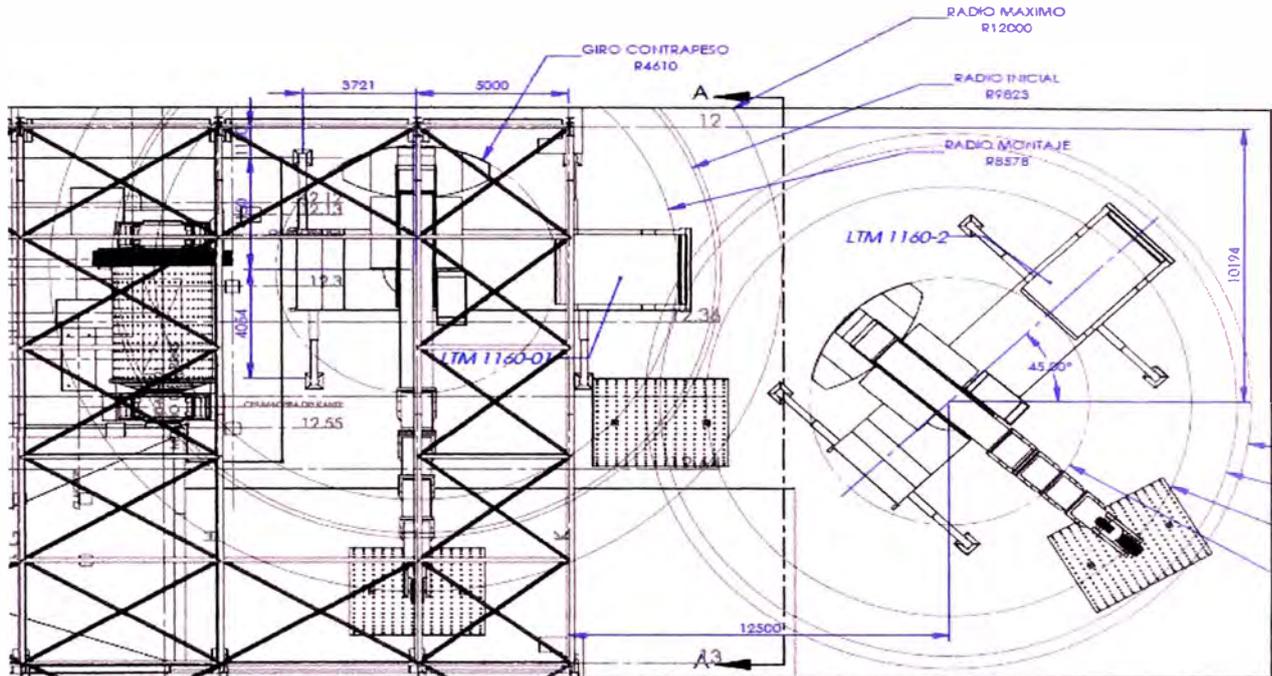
Vista de Planta del rigging plan – Montaje de de Shell del Molino de Barras
